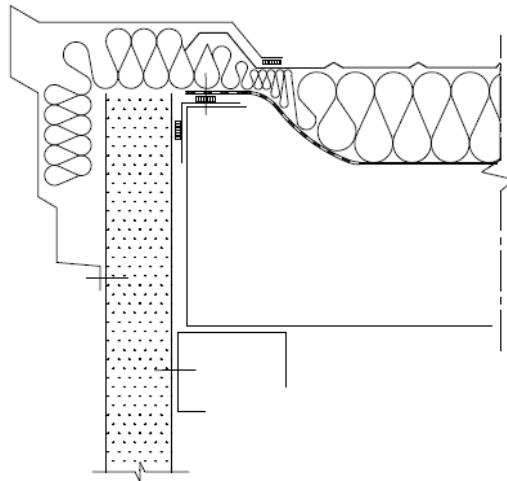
2: Beispiel für einen Dachrandabschluss, Wand aus Sandwichplatten, Industriedach mit Stahltrapezprofilen, als einschalige Konstruktion
